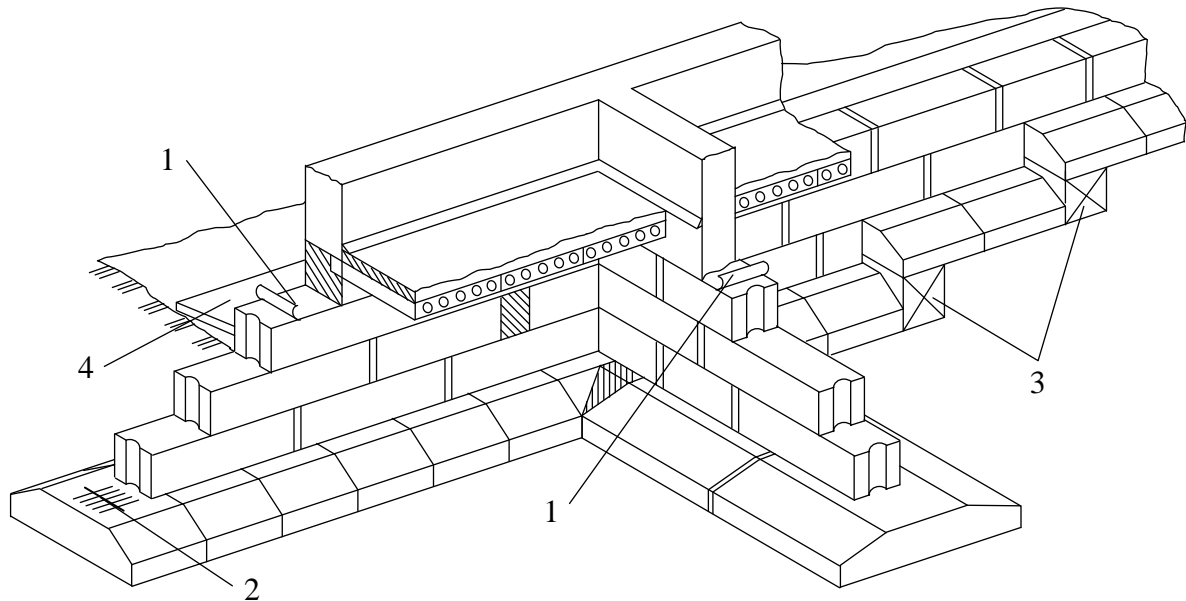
Конструкція збірного стрічкового фундаменту:
